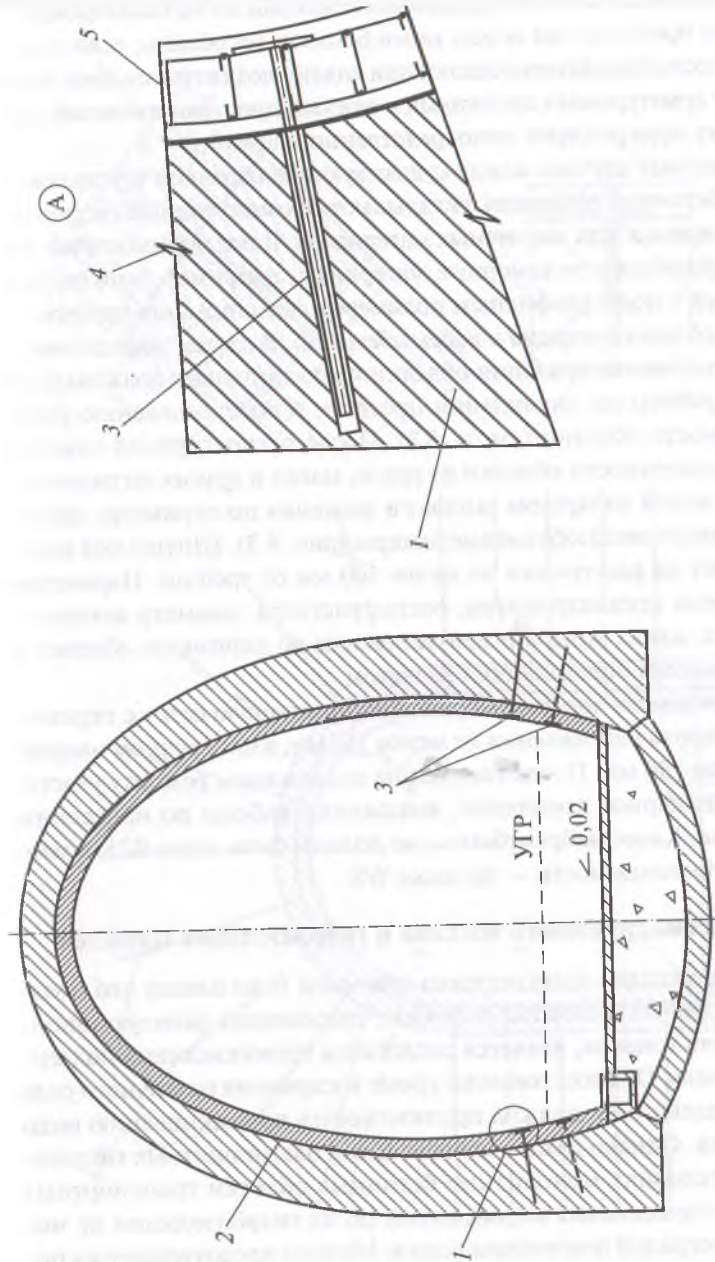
Усиление обделки железобетонной рубашкой:
